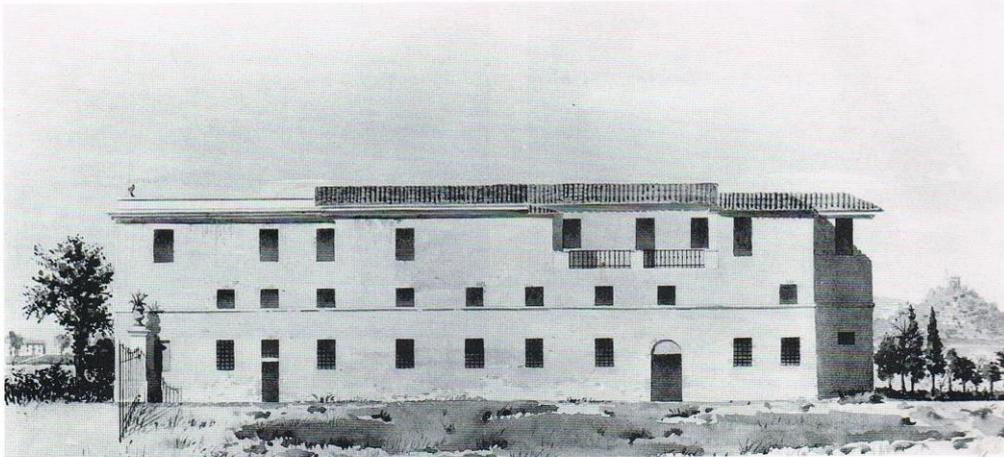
Prospetto ovest di villa Pianciani, acquerello (Collezione privata).
